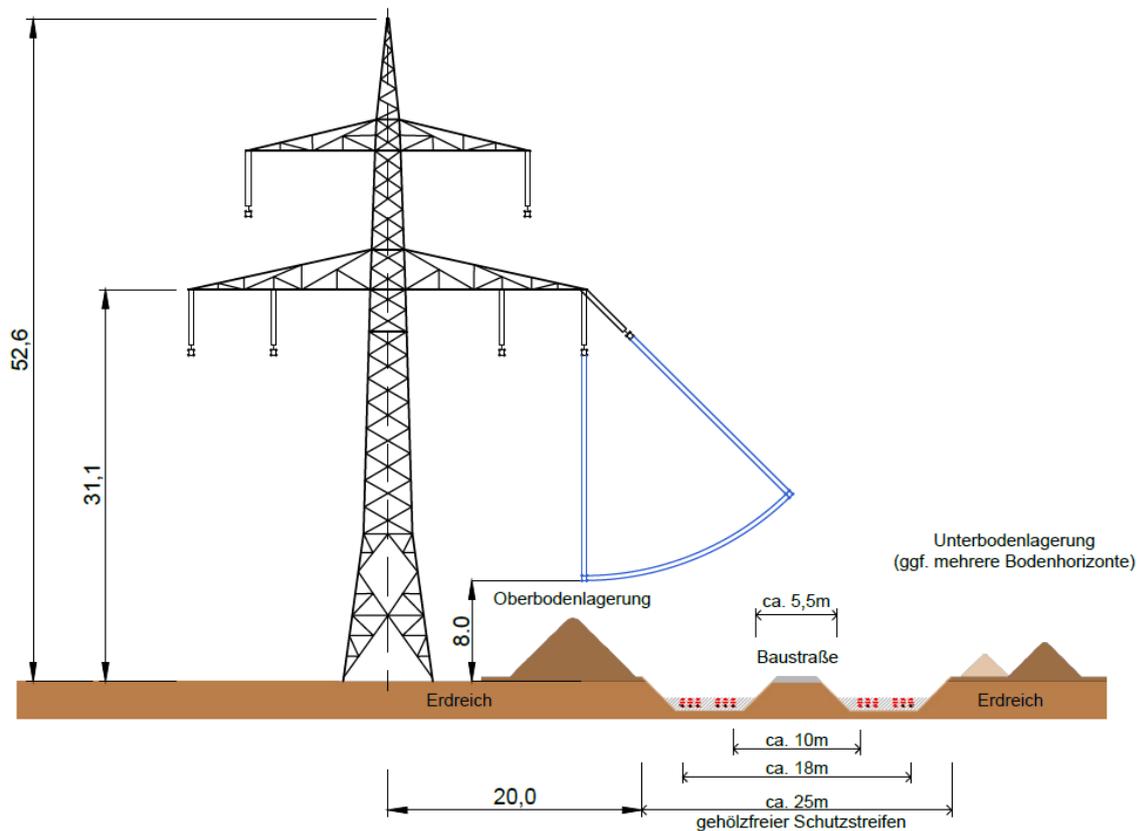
Parallelführung 380-kV-mit Erdkabeltrasse mit einer bestehenden Freileitung (alle Maße in m)
